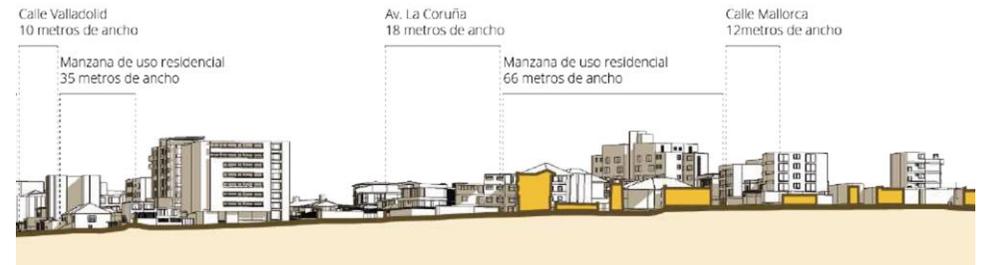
Levantamiento 3D, Fachadas La Floresta
